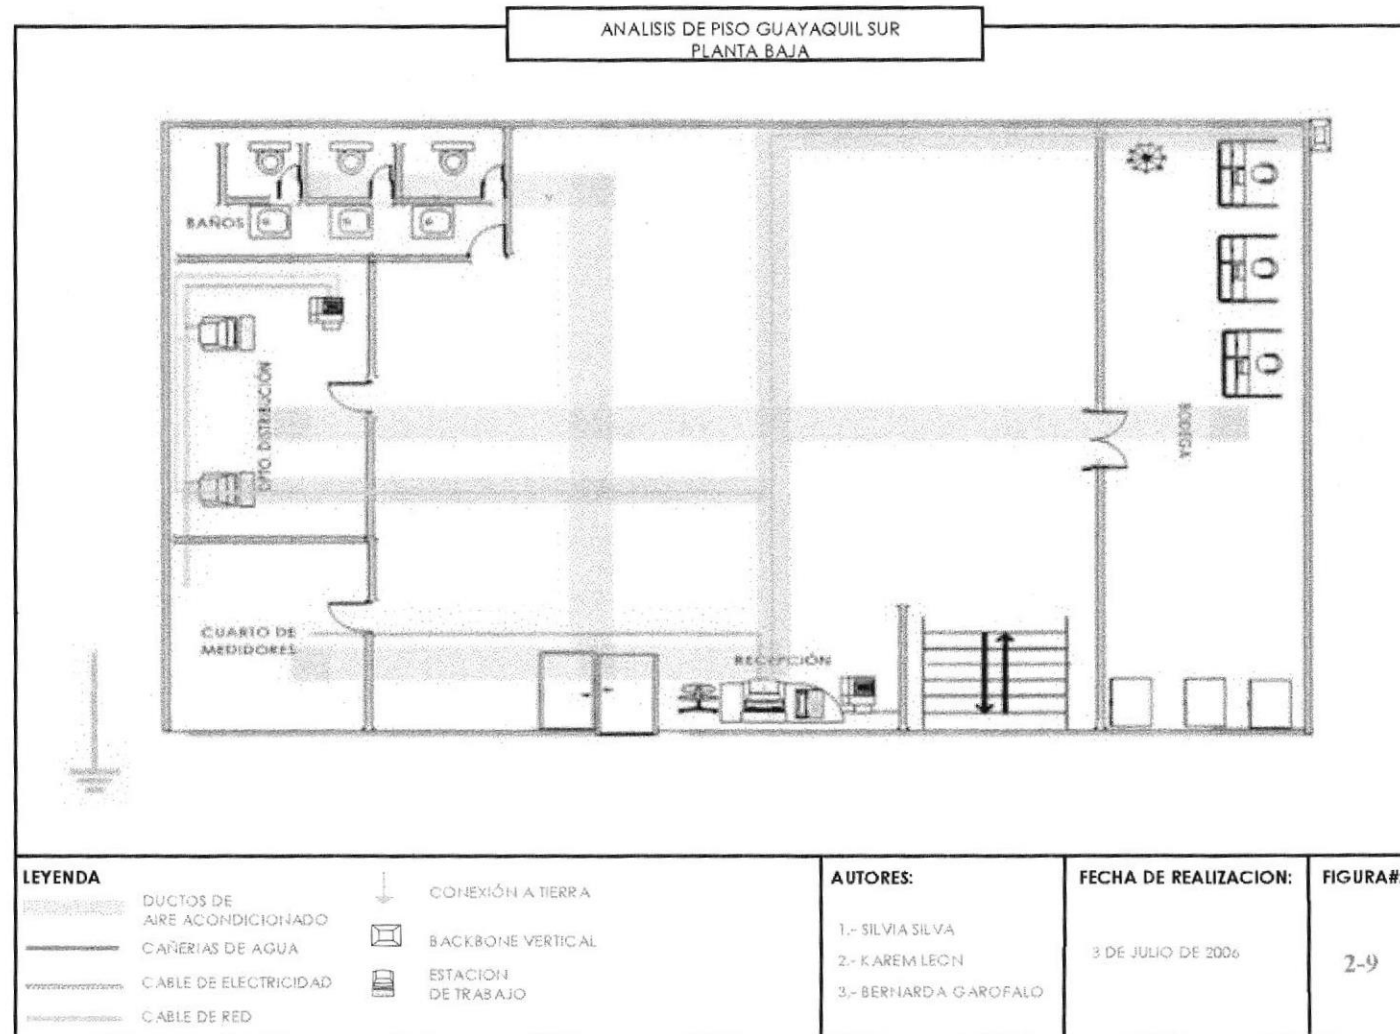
Situación Actual de Planta Baja-Edificio Sur
